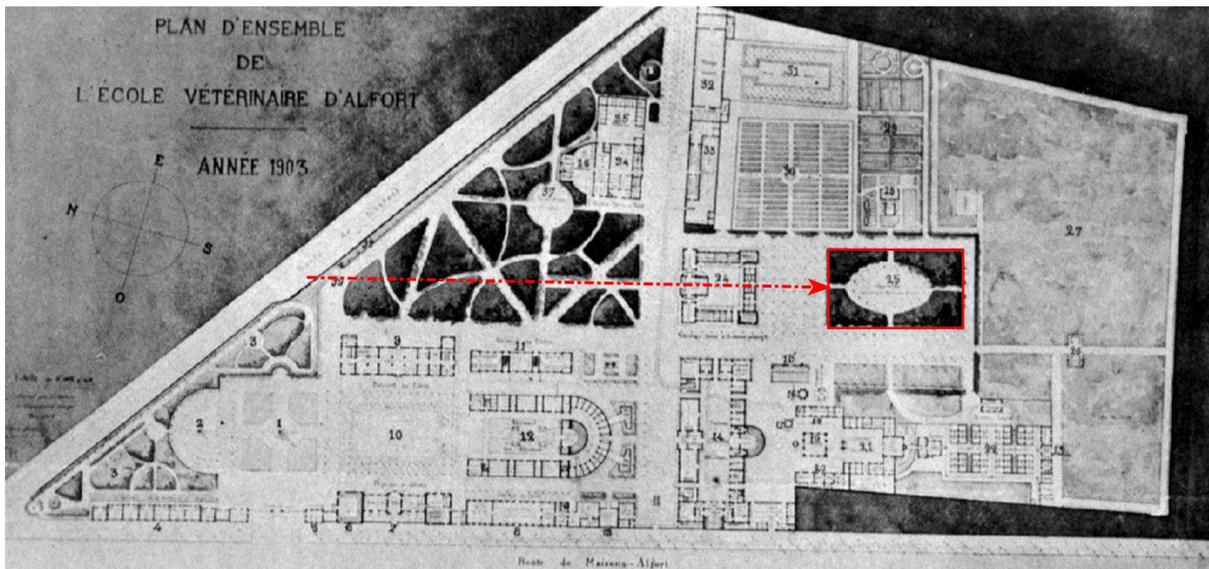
Bâtiment Brion ayant été construit à l'emplacement d'une « Pièce verte ». Plan de 1903. @ArtBuild
